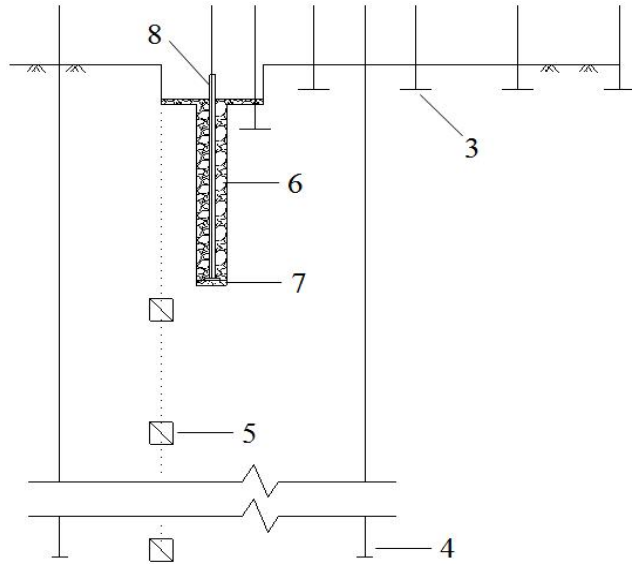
砂井浸水试验各标点布设剖面示意图
